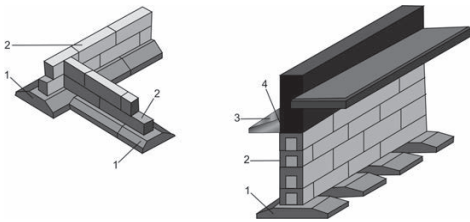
Схемы ленточного сборного фундамента: а — сплошного; б — прерывистого: 1 — фундаментные подушки; 2 — блоки стен подвала; 3 — отмостка; 4 — гидроизоляция
